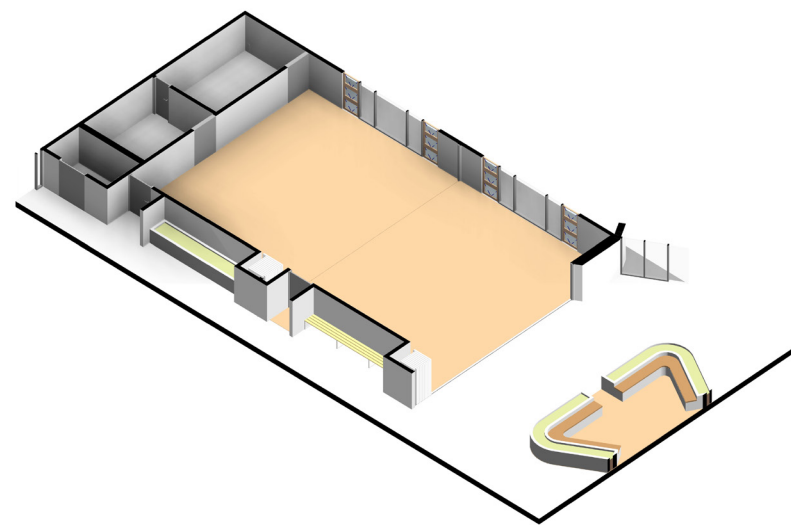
Sala multiuso con puertas plegables abiertas.
